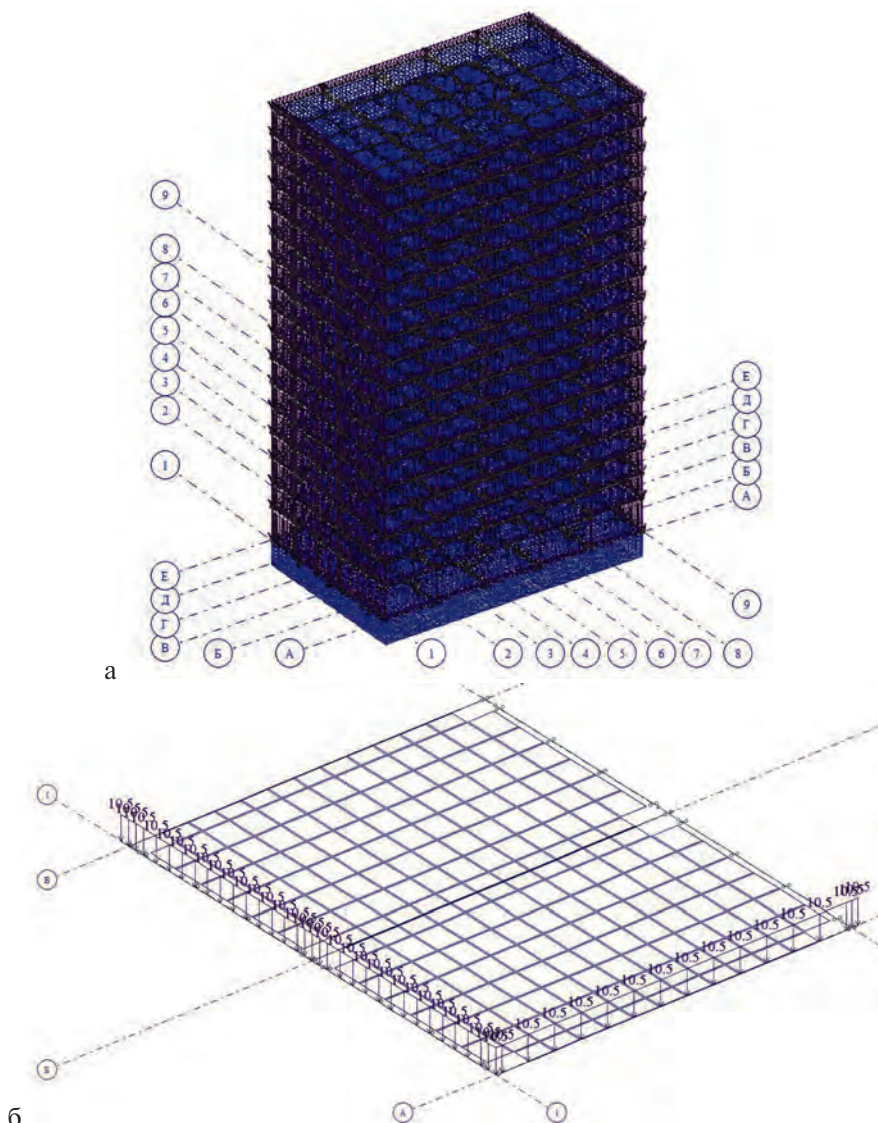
Загружение № 4. Нагрузка на всю расчетную схему (а) и фрагмент перекрытия с нагрузкой на контурные балки типового этажа (б)
